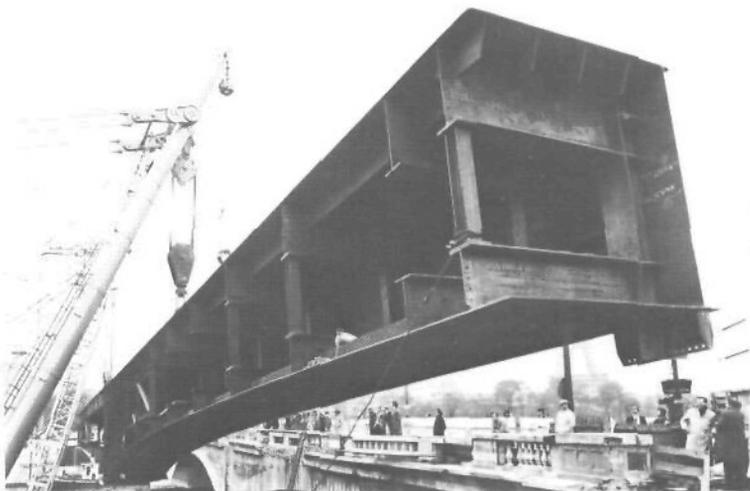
La précision de mise en place à la bigue permet d'amener en coïncidence parfaite l'assemblage boulonné en croix situé à l'extrémité droite, avec son vis-à-vis en attente sur la culée. Remarquer les montants verticaux provisoires qui joignent les demi-entretoises, inférieure et supérieure ; on obtient ainsi des sections fermées.
